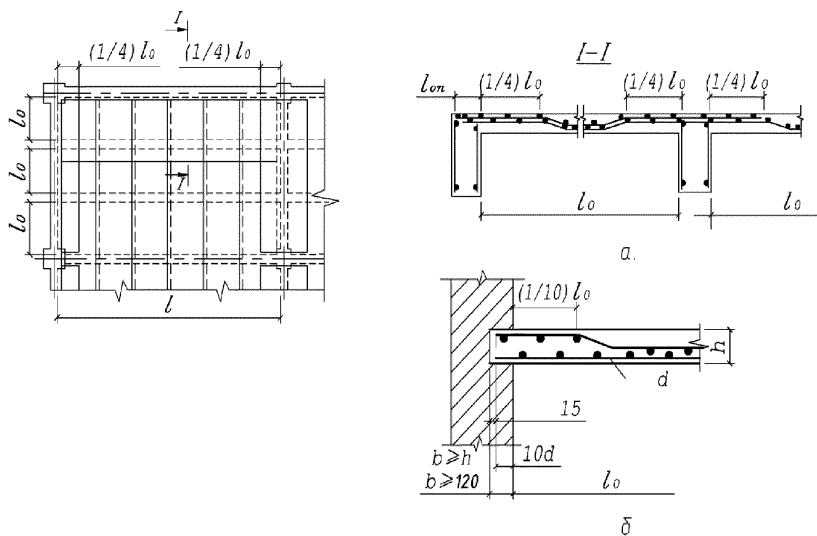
Непрерывное армирование монолитных неразрезных плит сварными рулонными сетками:
